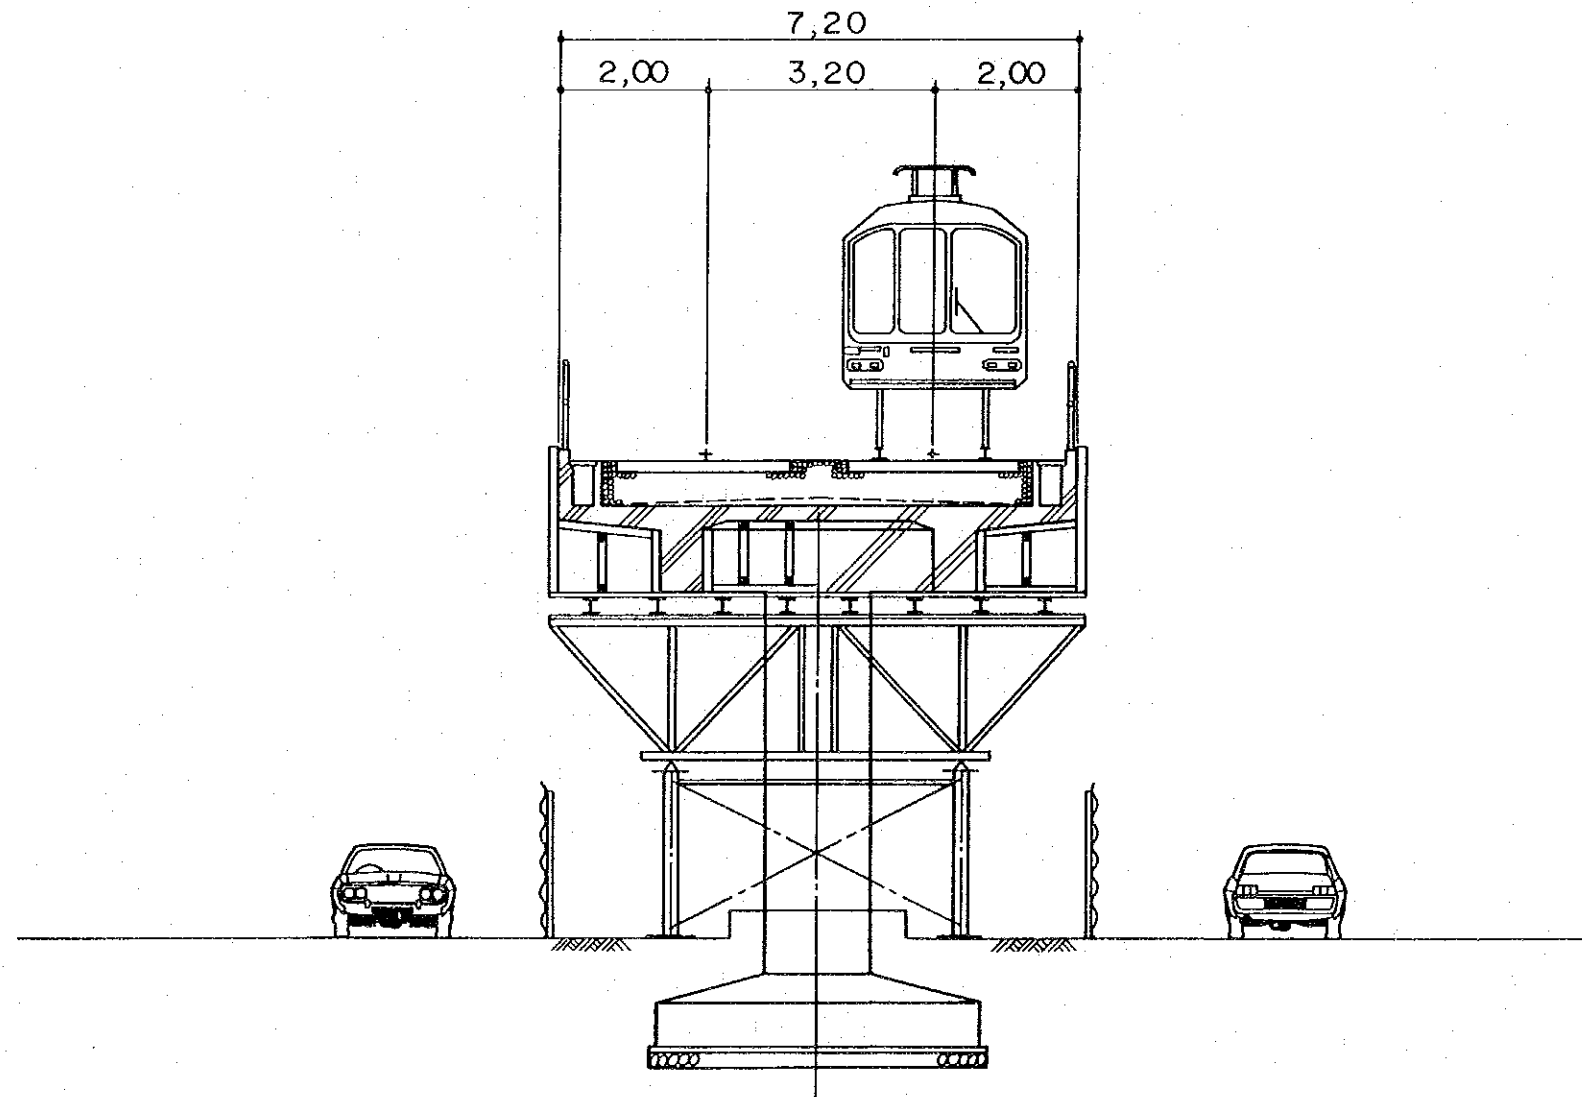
Réalisation de l'ouvrage surélevé à 2 lignes sur poteaux centraux
